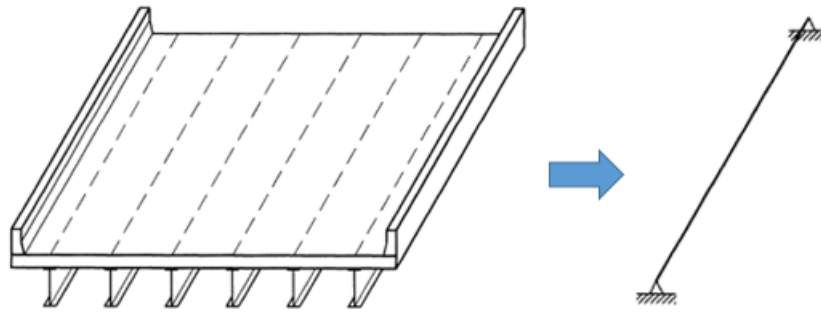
Idealização da ponte como viga. Fonte: Adaptado de Barker e Puckett (2014).
